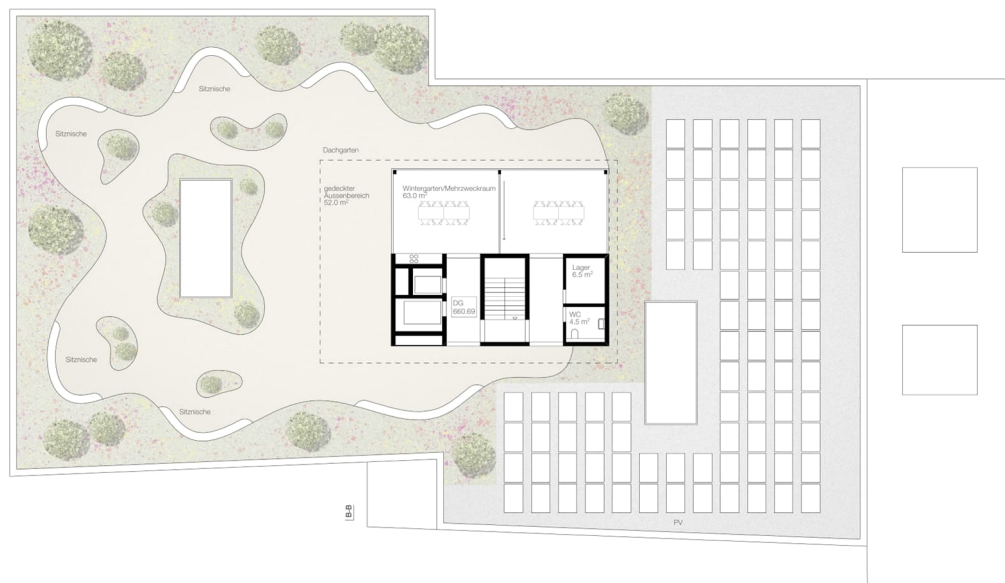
Grundriss Dachgeschoss (3. OG) IKIGAI (massstabslos)
